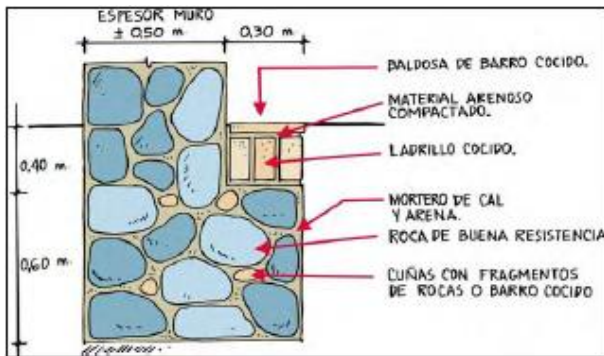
y 26: Viga de cimentación y sobrecimiento.
